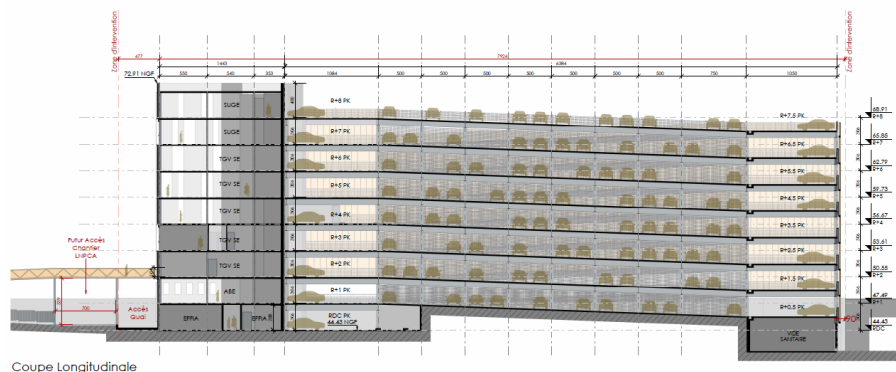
Immeuble provisoire Decking Voltaire coupe longitudinale (Source : APS Sud Architecte, 2025)
